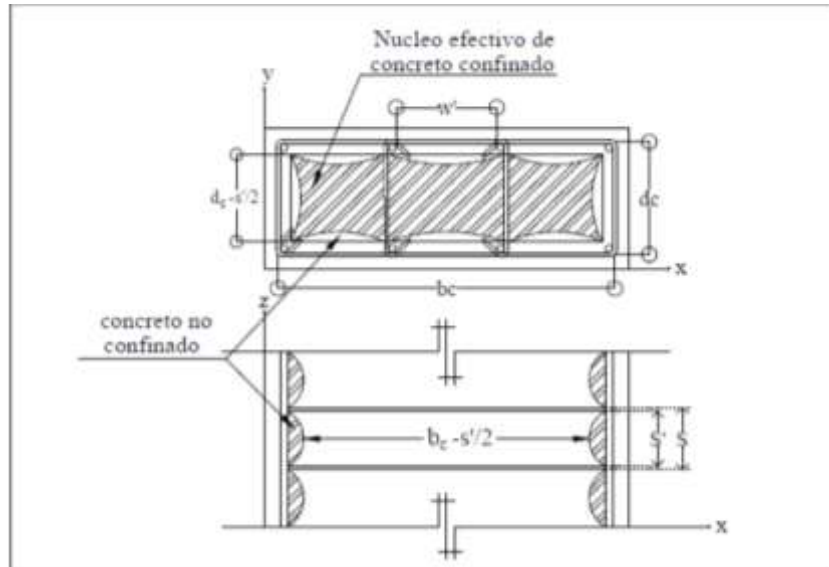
15-. Núcleo efectivo de hormigón confinado para una sección rectangular. (Mander et al. 1988).
